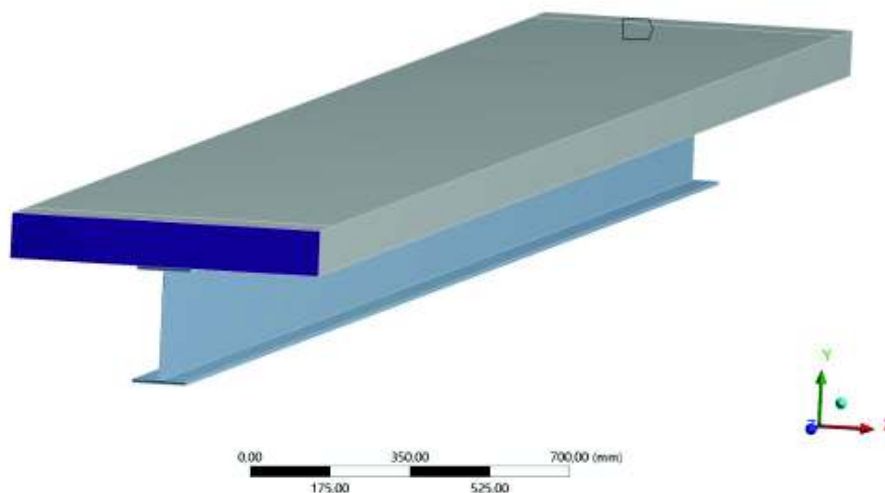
Apoyo simple derecho de la viga metálica V4
